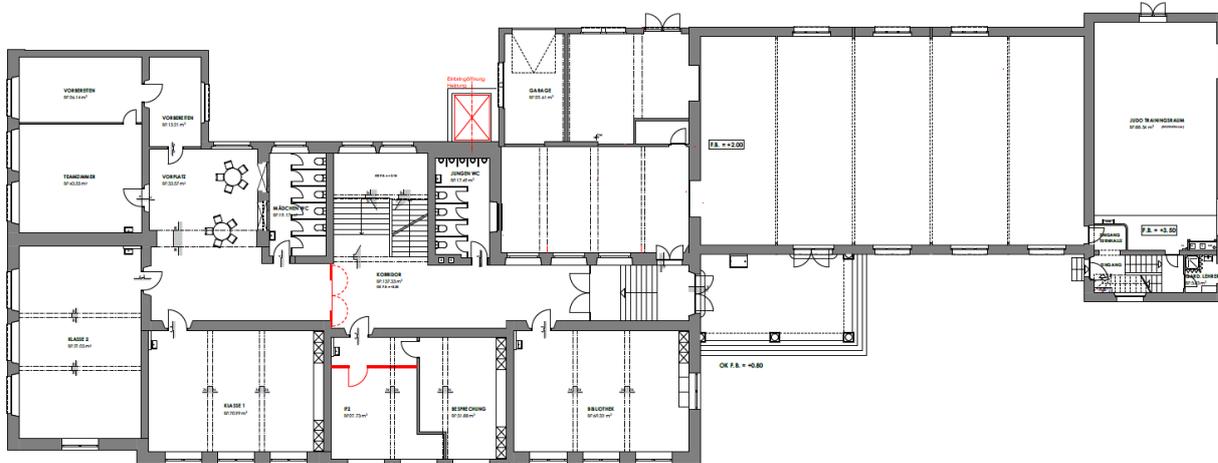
; Grundriss Erdgeschoss Haupttrakt (1. Teilsanierung)
